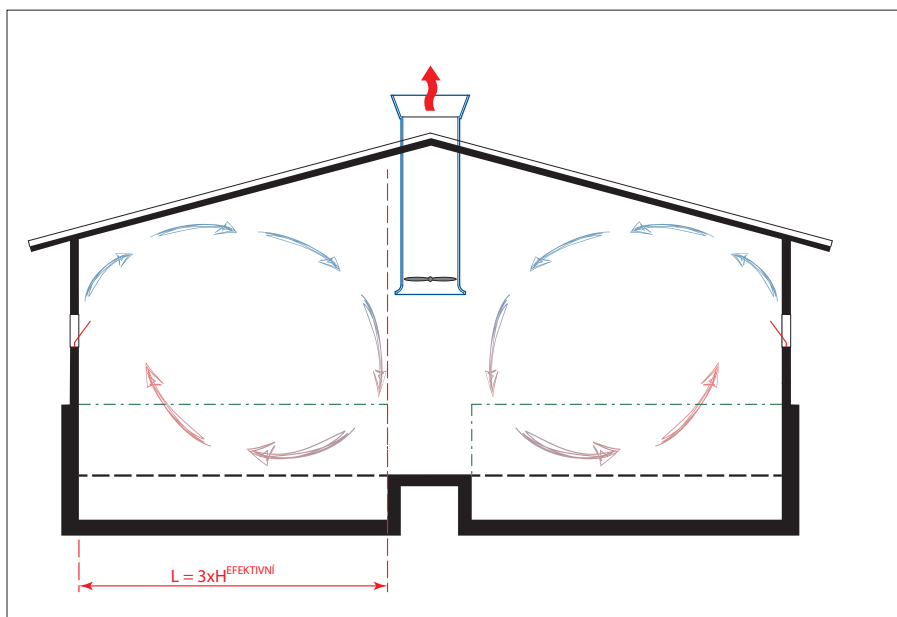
Zobrazení efektivní výšky u různých typů stájí
